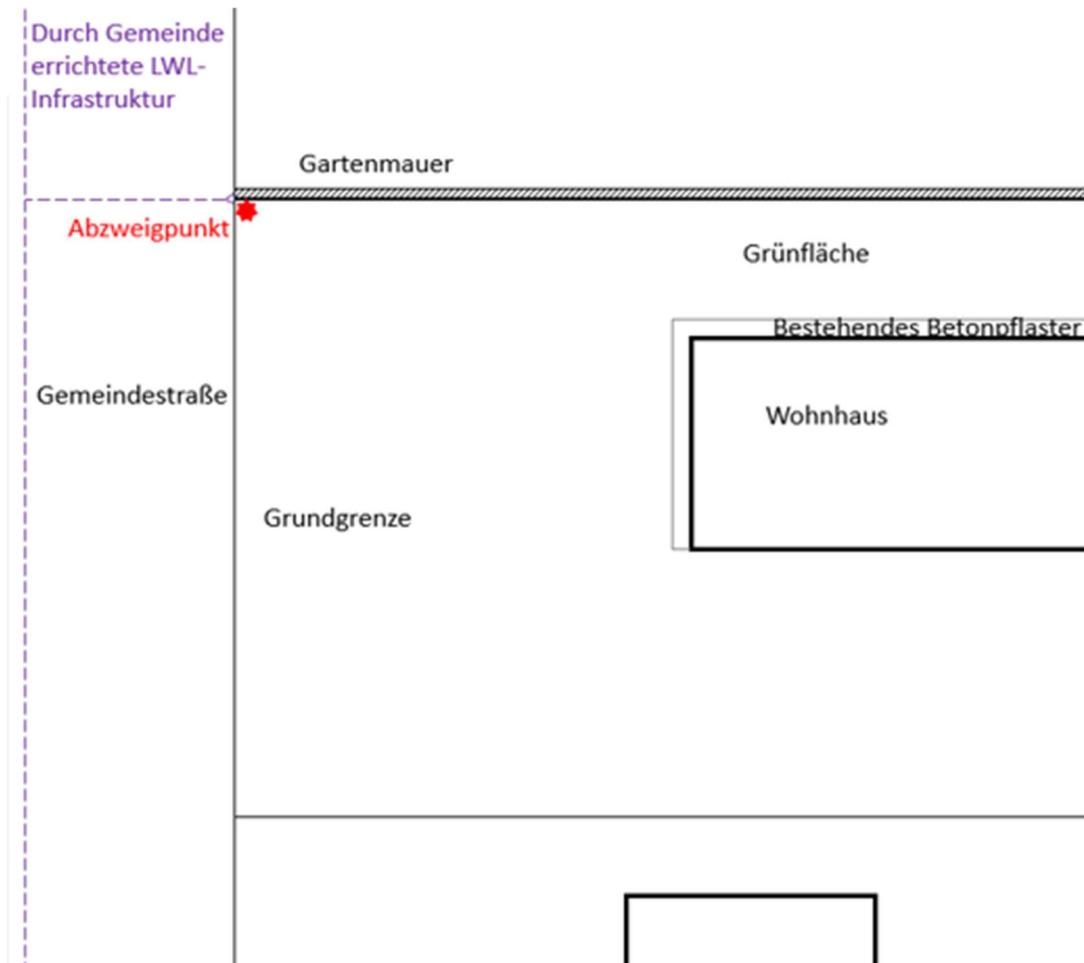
Ausschnitt Lageplan, Abzweigpunkt (rot markiert)
